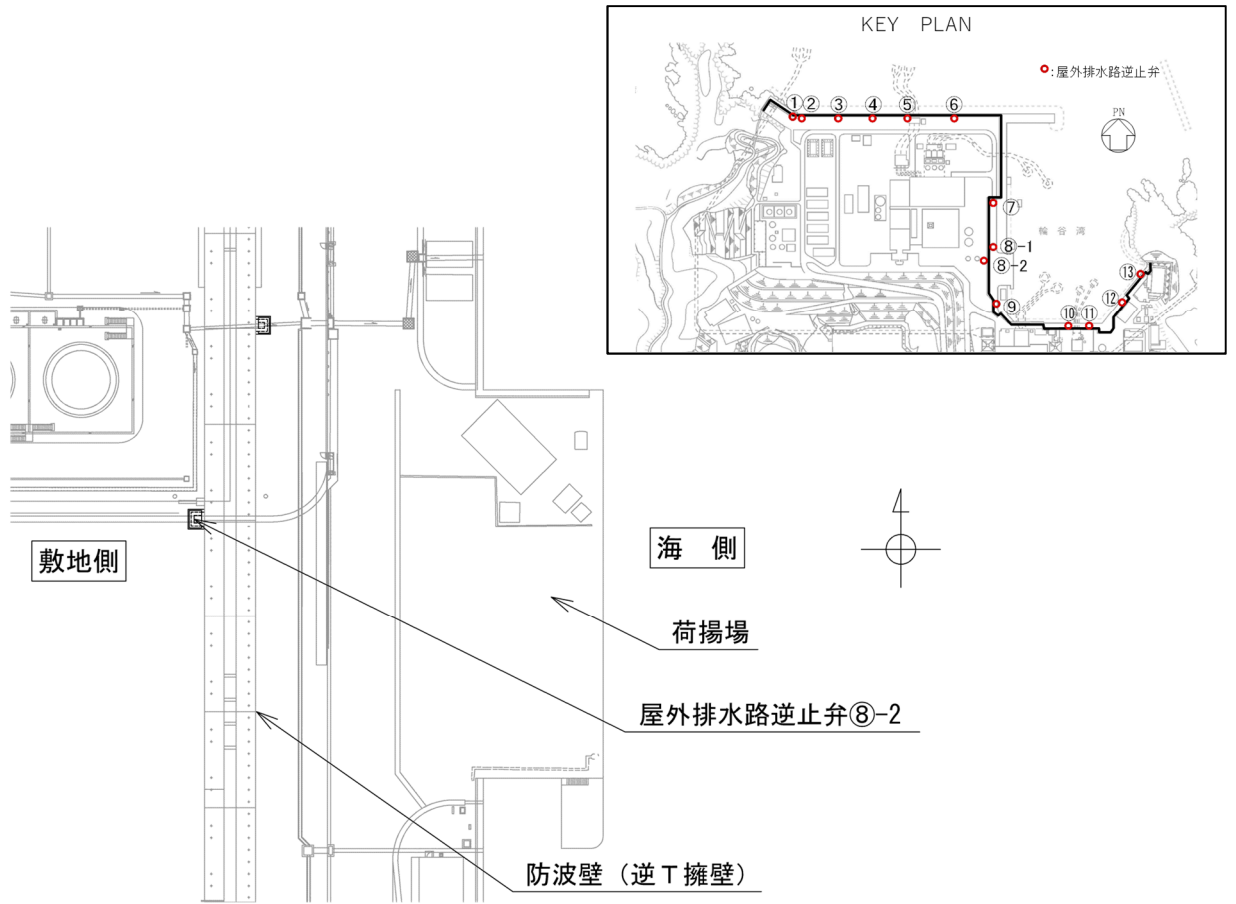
(1) 屋外排水路逆止弁⑧-2 平面图
